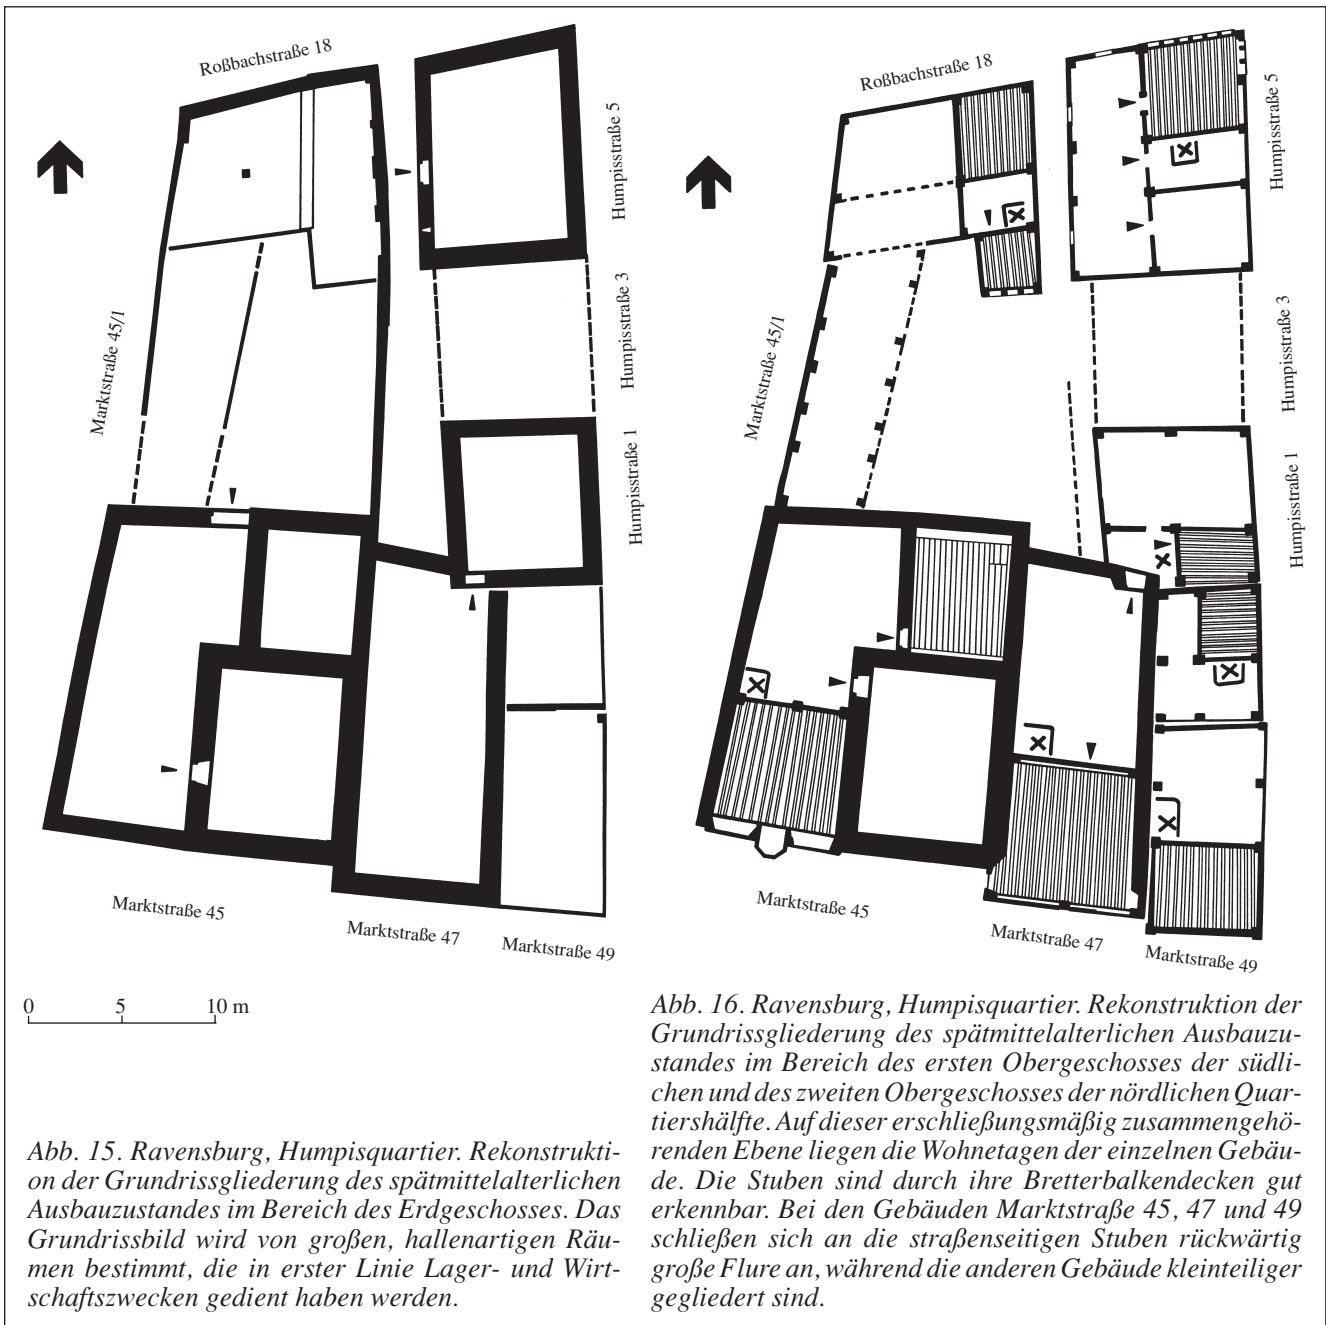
Ravensburg, Humpisquartier. Rekonstruktion der Grundrissgliederung des spätmittelalterlichen Ausbaustandes im Bereich des Erdgeschosses. Das Grundrissbild wird von großen, hallenartigen Räumen bestimmt, die in erster Linie Lager- und Wirtschaftszwecken gedient haben werden.
